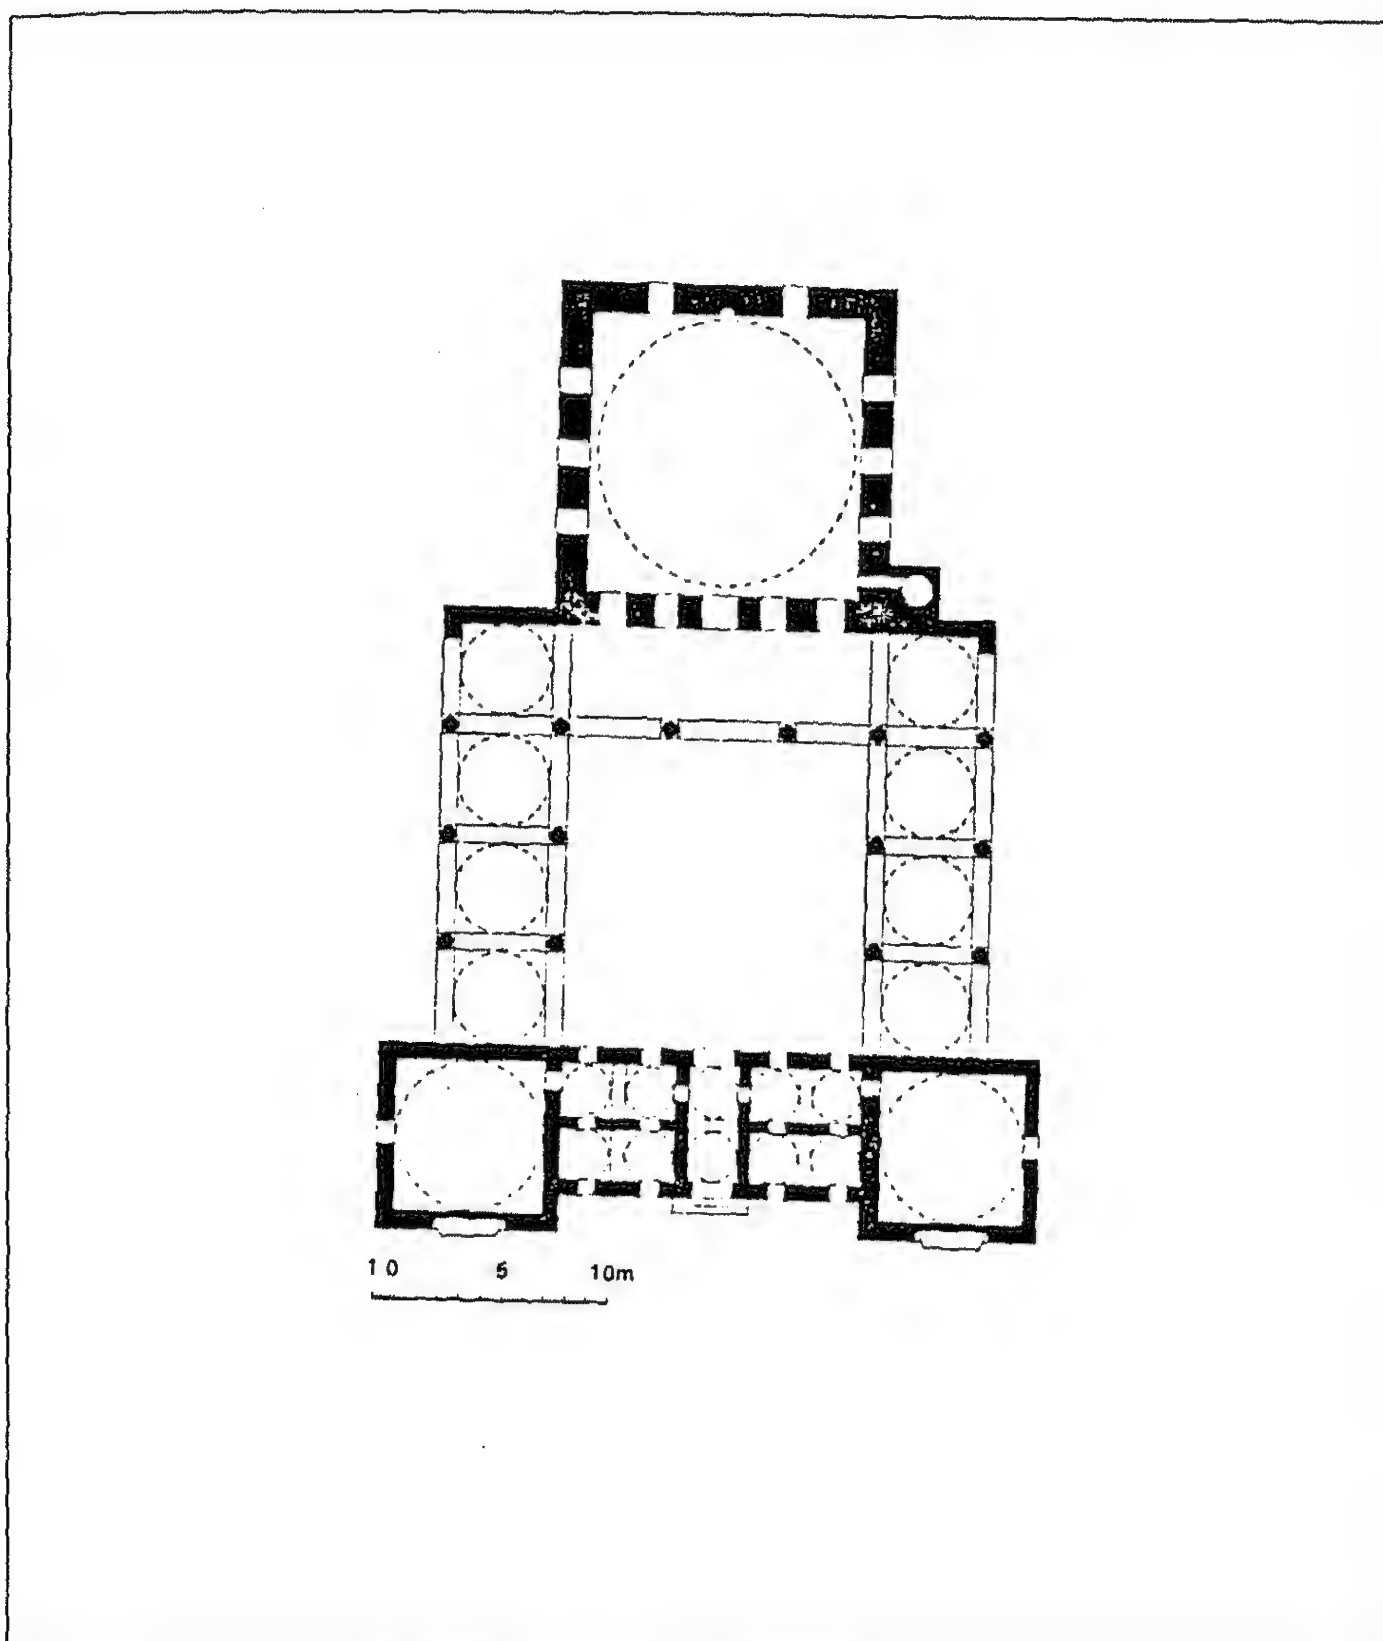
مسقط أفقي لمجمع السليمية في أدرنة (عن: Cezar).
